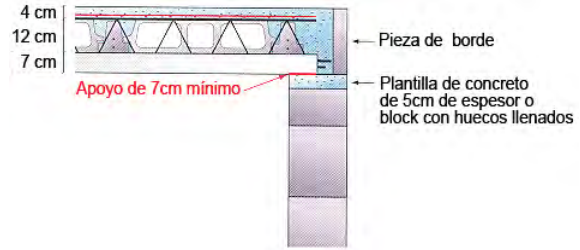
DETALLE DE APOYO PERPENDICULAR AL MURO DE CARGA
